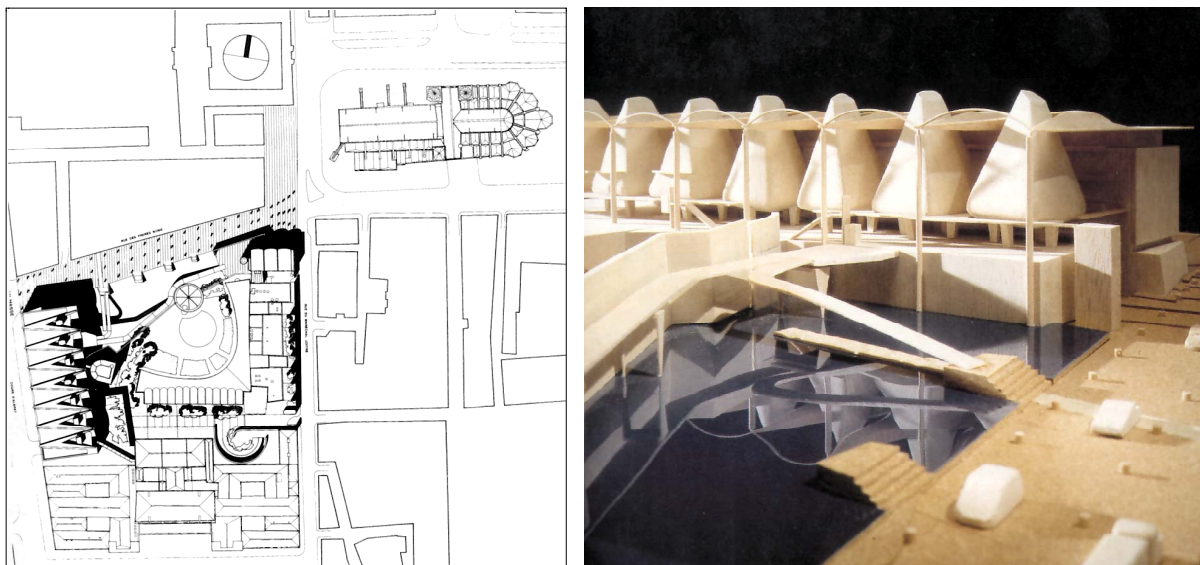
Plan masse et maquette du projet remis au concours, publiés par Architectural Review n° 409, mars 1993
